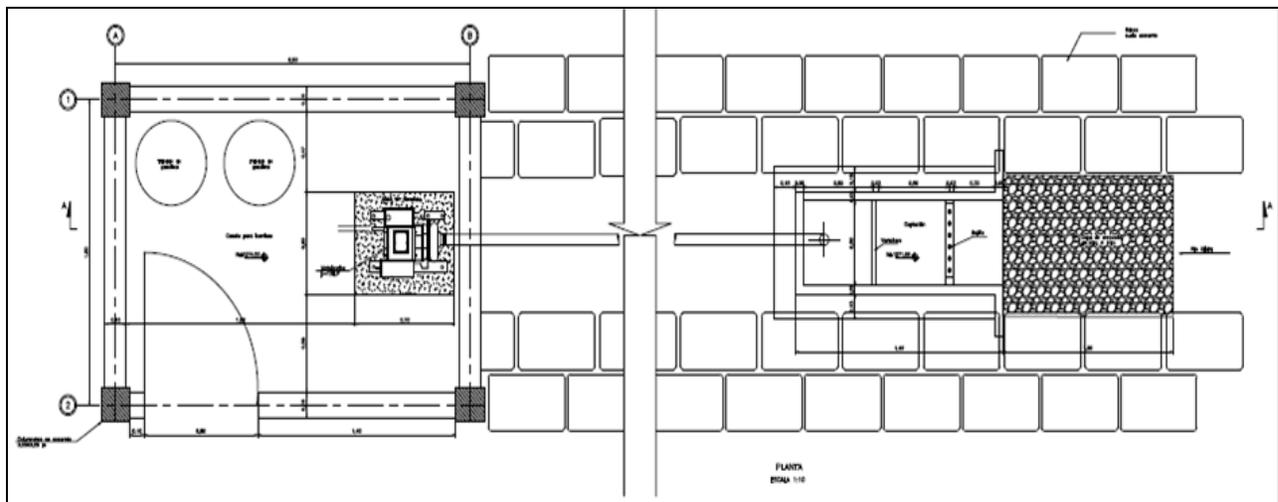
Vista en planta de la estructura de captación para el río Oibita - bocatoma lateral
